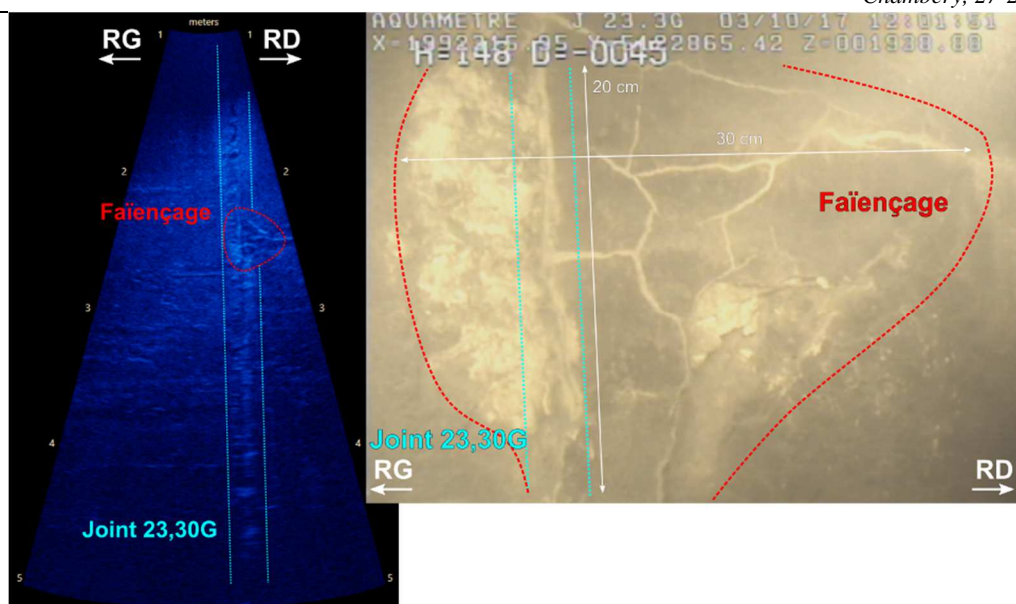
Observation à la caméra acoustique (à gauche) et à la caméra télévisuelle (à droite) d'un défaut de faièçage sur le parement amont du barrage voûte rive gauche de Plan d'Aval
